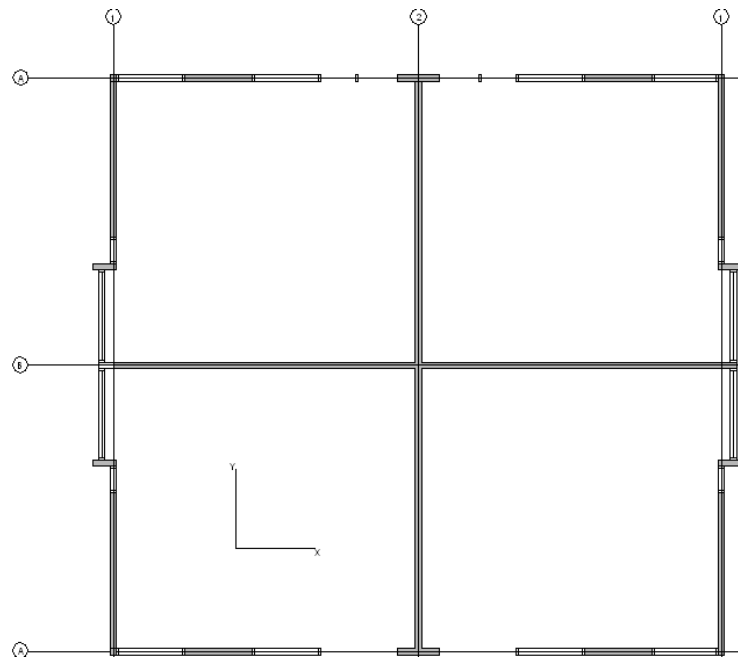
26. Planta tipo Edificios Villa Cordillera
